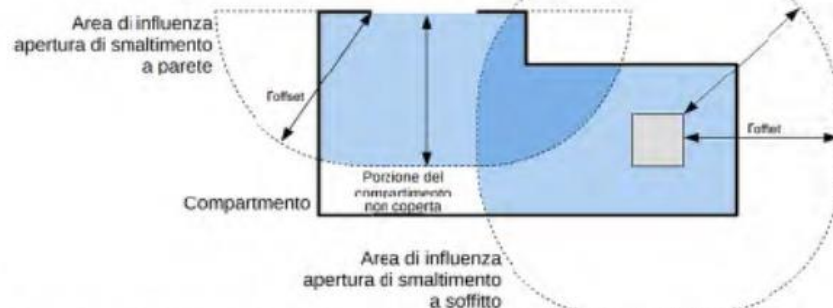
Verifica dell'uniforme distribuzione in pianta delle aperture di smaltimento
